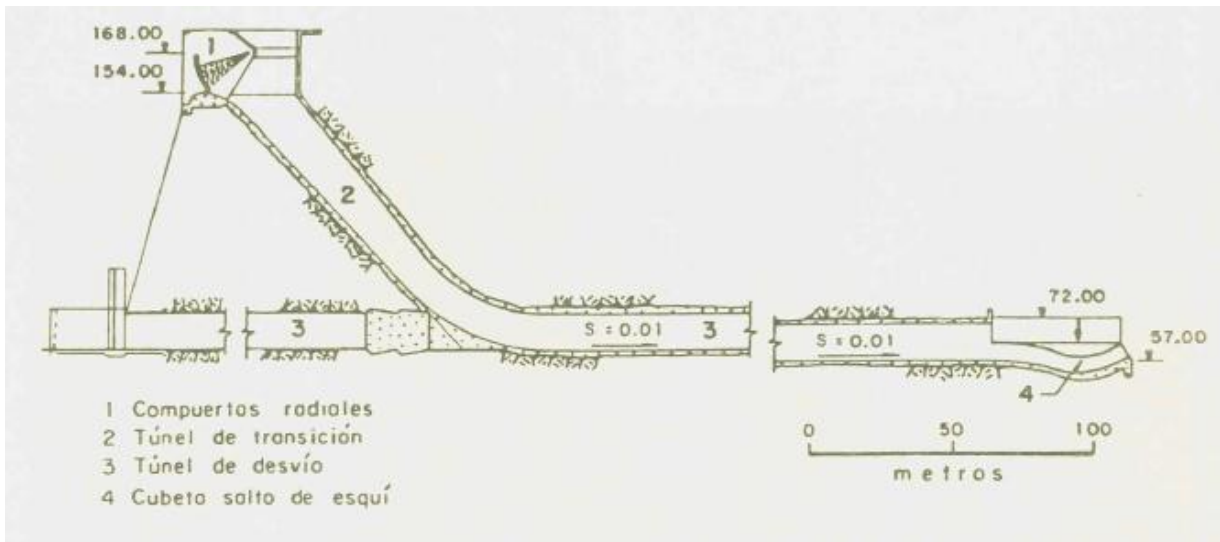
Vista del perfil de un vertedor en túnel, presa “El Infiernillo”.
